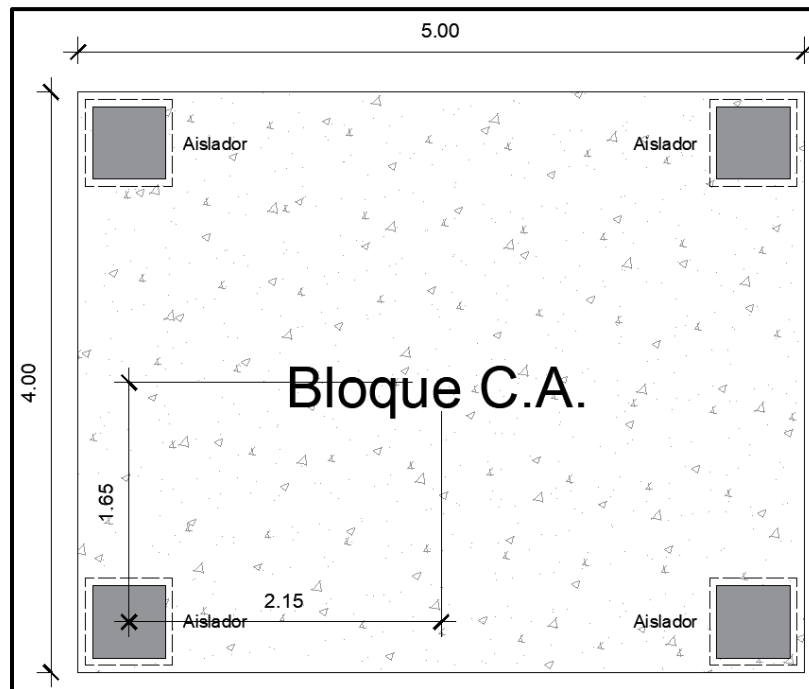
Vista de planta del bloque de AMS para 2%. Fuente:
